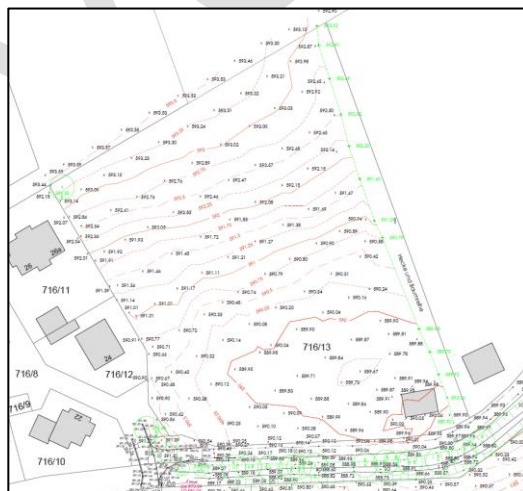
Planausschnitt Vermessung; Quelle Plan: MAK Vermessung GbR, 21.01.2020
